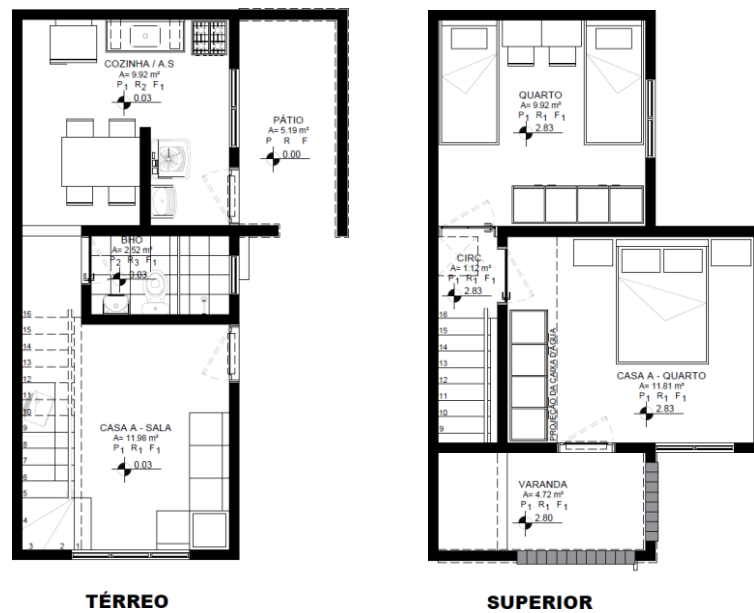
Planta-baixa Tipo A. Fonte: Aflalo (2016)
